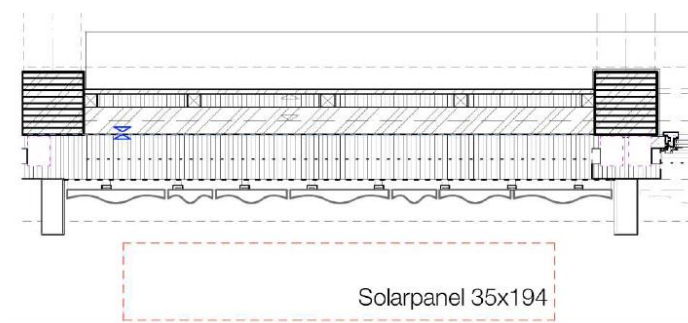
PV-Anlage Fassadenband und Fensterbank: Grundriss
